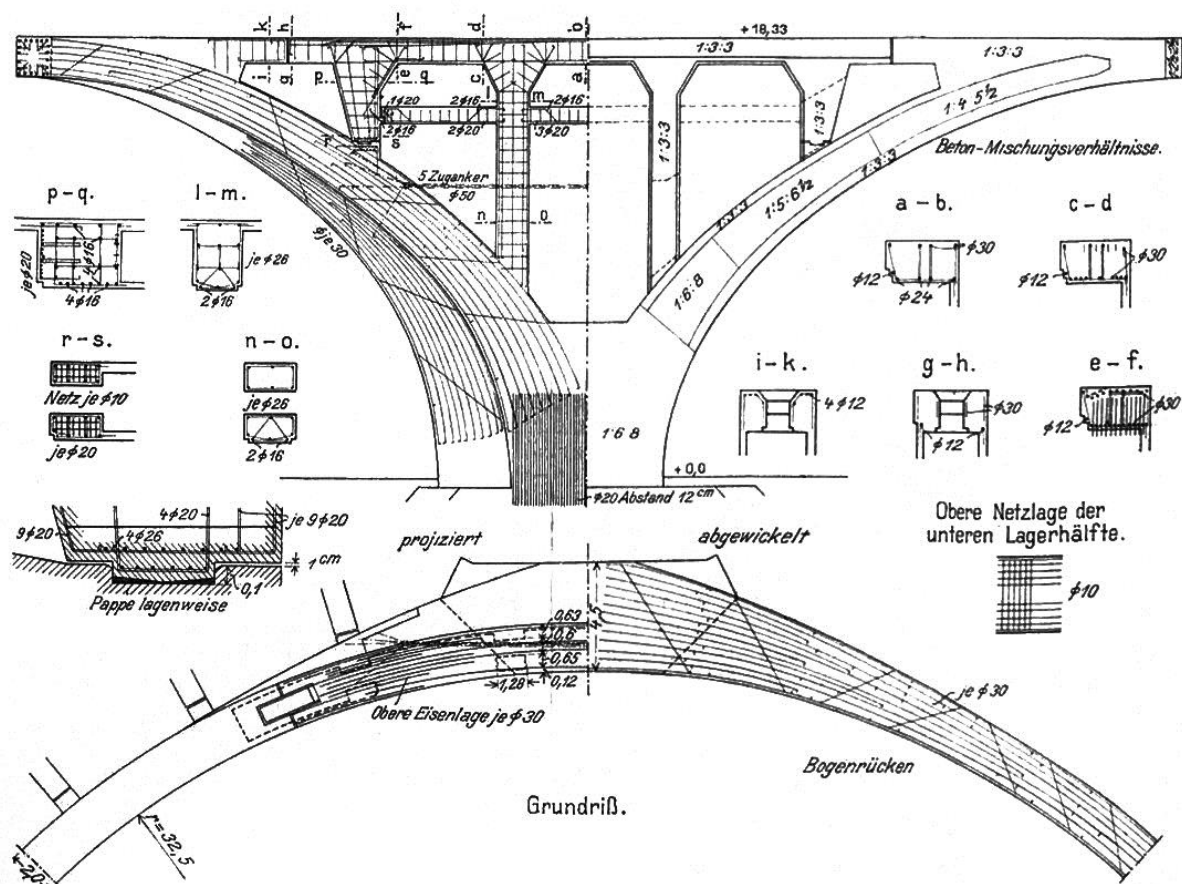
Hauptbögen und Windrahmen: Bewehrung und Beton-Mischungsverhältnisse
